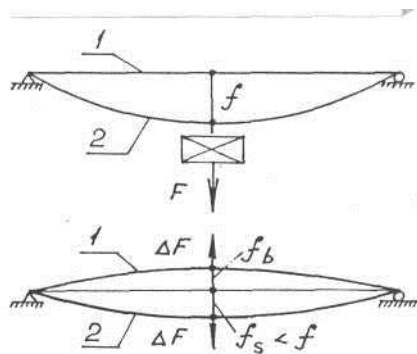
(1 — железобетонная балка, 2 — стальная балка)
